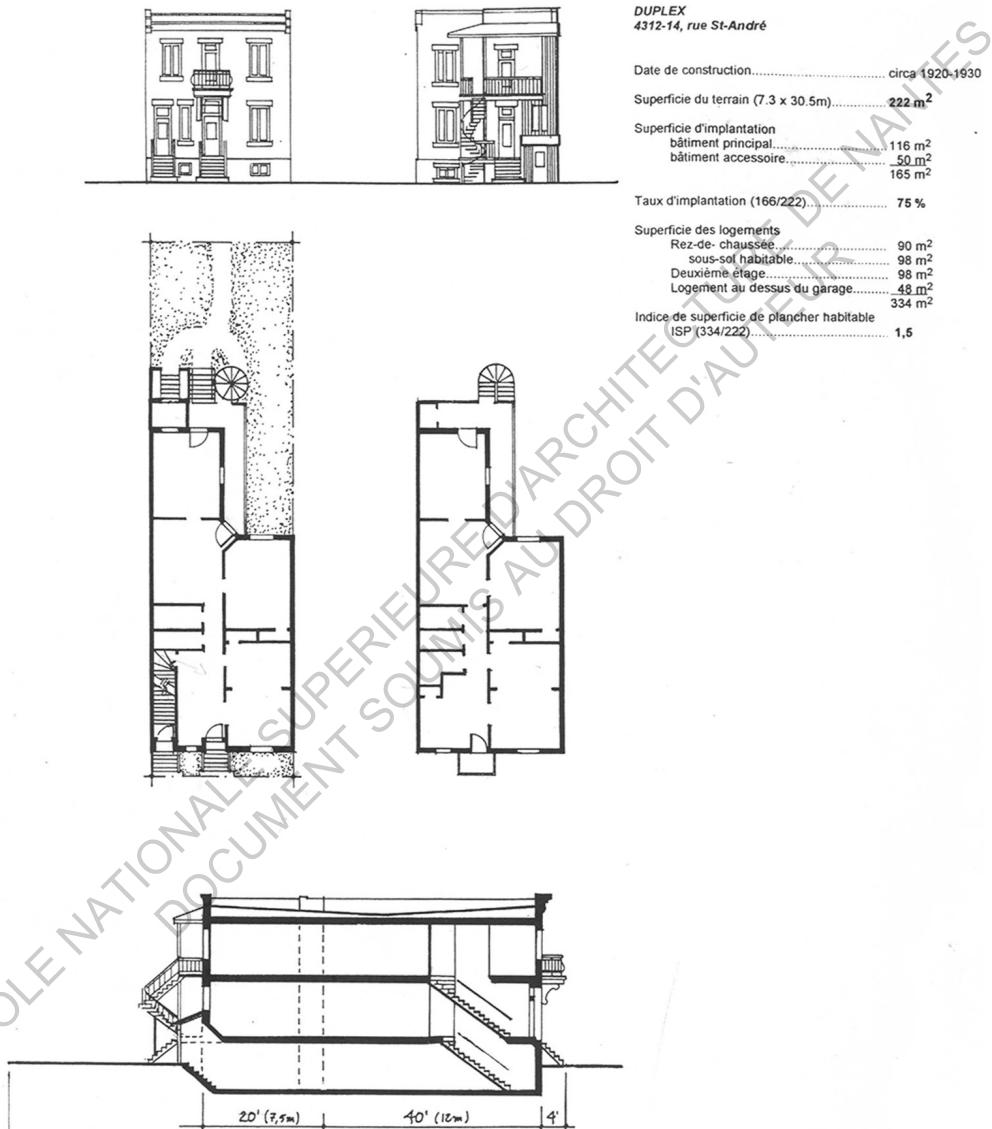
Plans, coupe et élévation d'un duplex, rue St André
